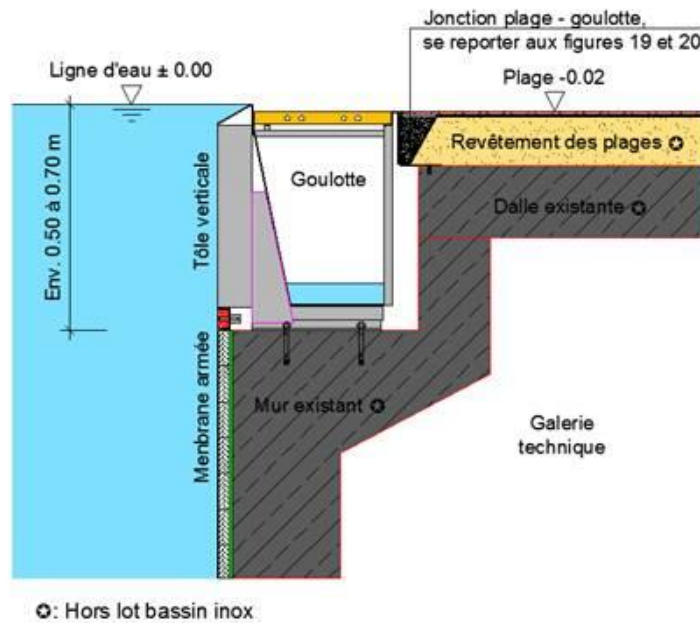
Détail d'étanchéité à la liaison tête de paroi et revêtement en membrane armée
